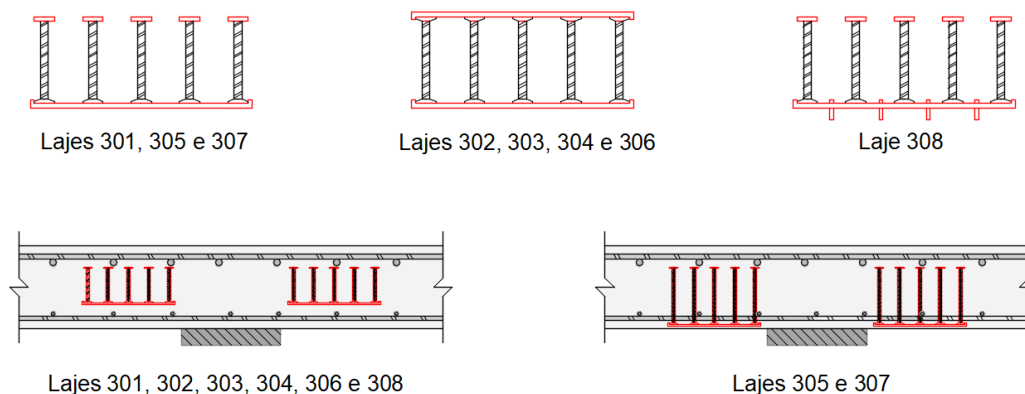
Propriedades das armaduras de cisalhamento de Andrade (1999)
